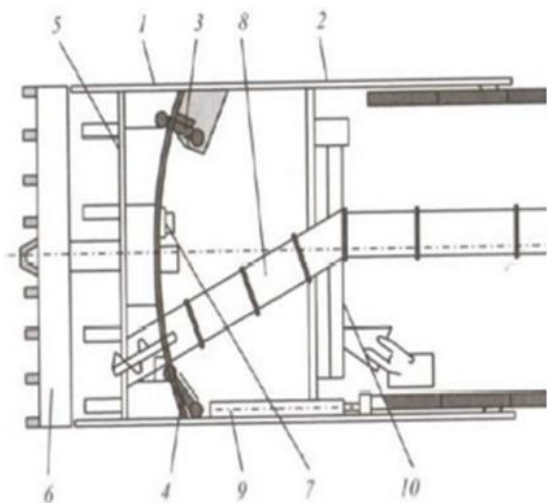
Конструктивная схема щитовой машины с шарнирным корпусом третьего вида
